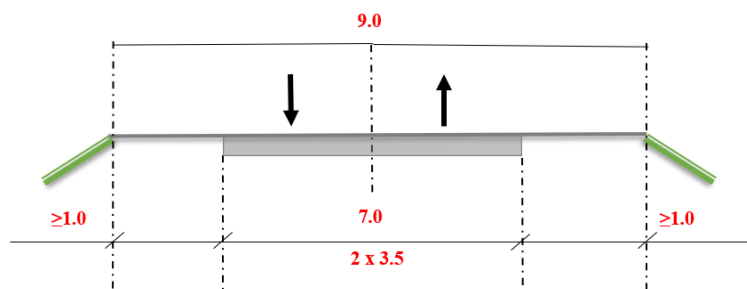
Typowe przekroje dróg głównych G [128]
